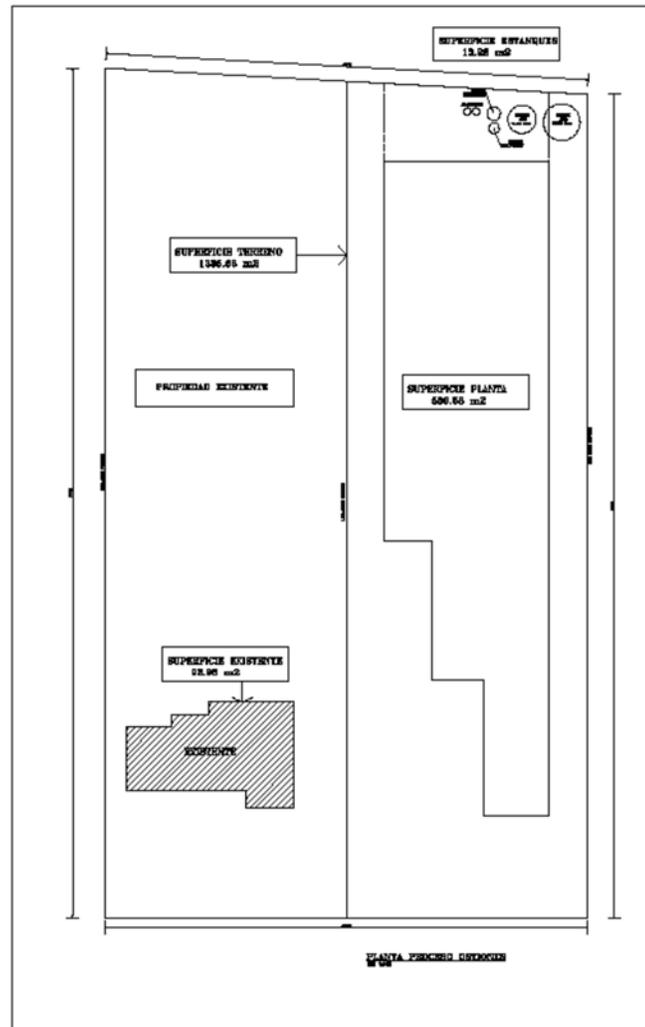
Planta de proceso: superficie considerada para construir la planta en el terreno del barrio industrial de Tongoy.
